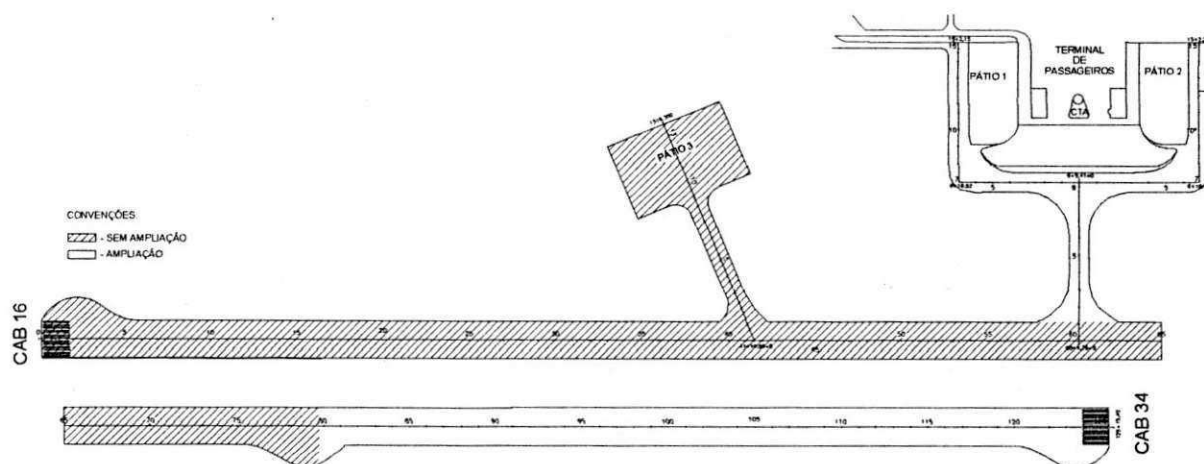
Pavimento existente e pavimento ampliado -Aeroporto Internacional Presidente Castro Pinto
